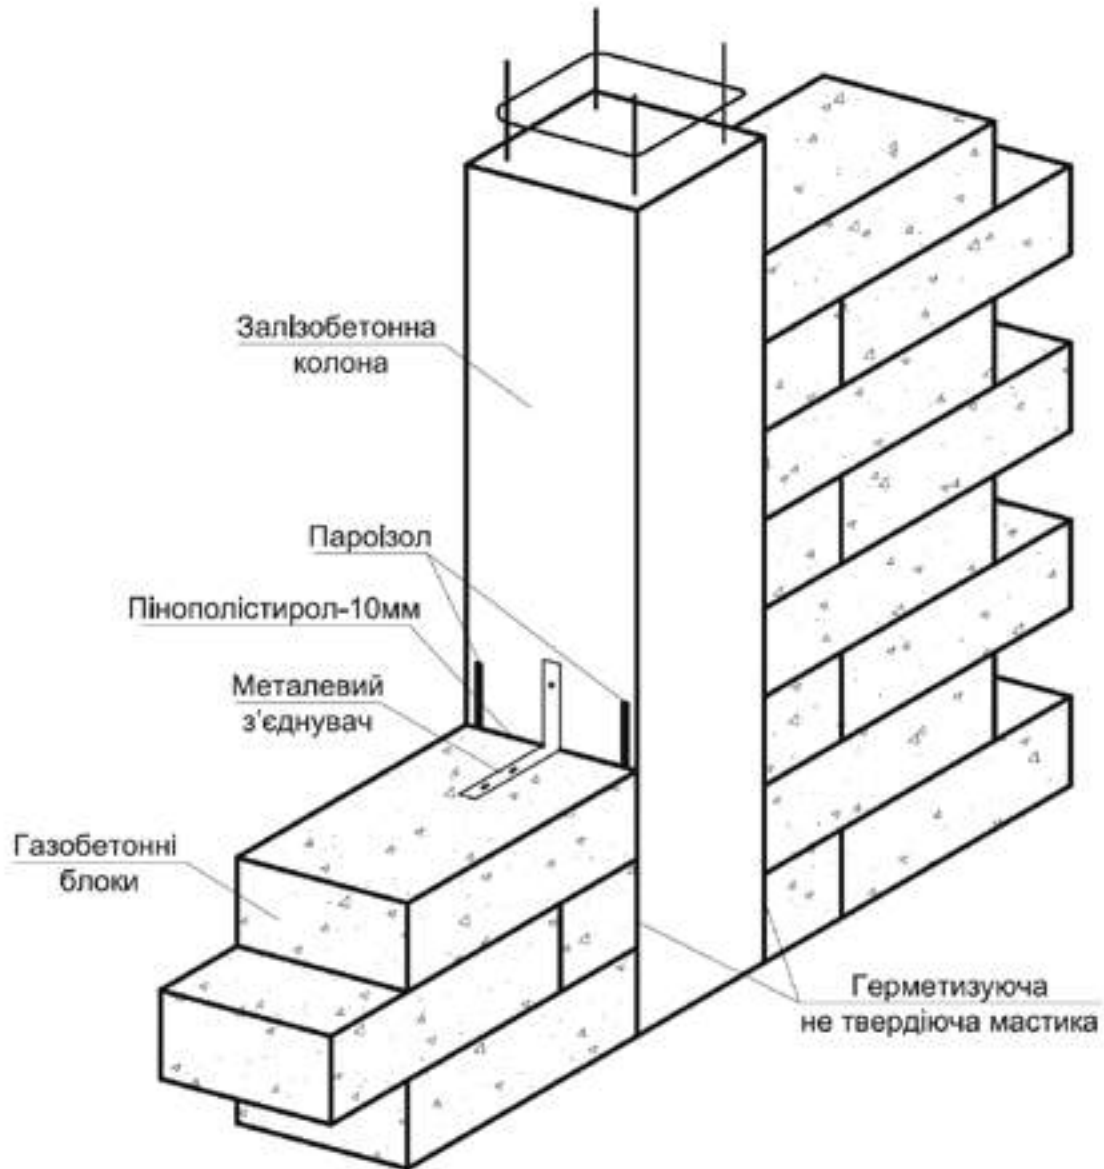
З'єднання стіни, заповнюючий каркас із залізобетонною колоною
